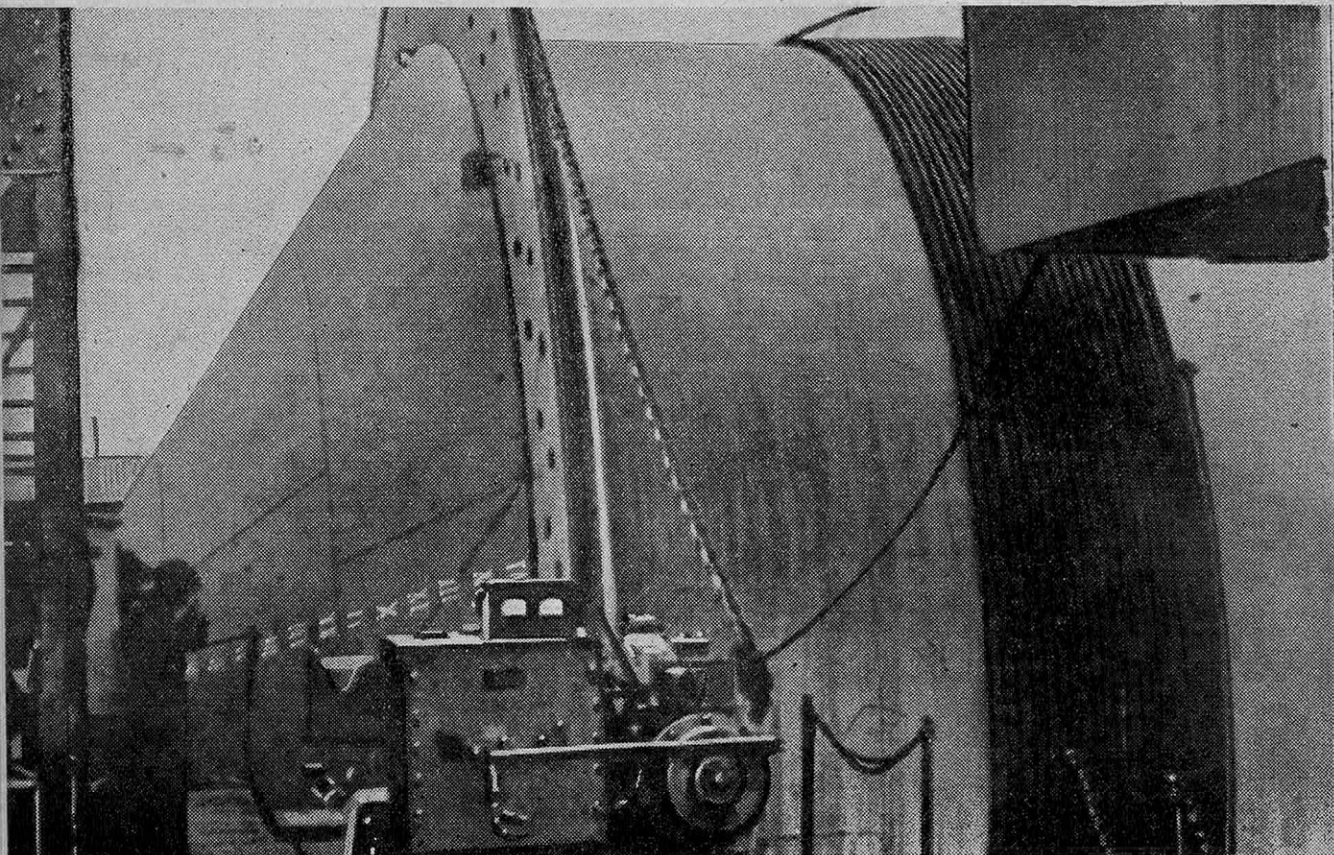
STOCKAGE DU PIPE-LINE D'ACIER, PAR TRONÇONS SOUDÉS DE 1200 M, SUR LA COTE ANGLAISE
